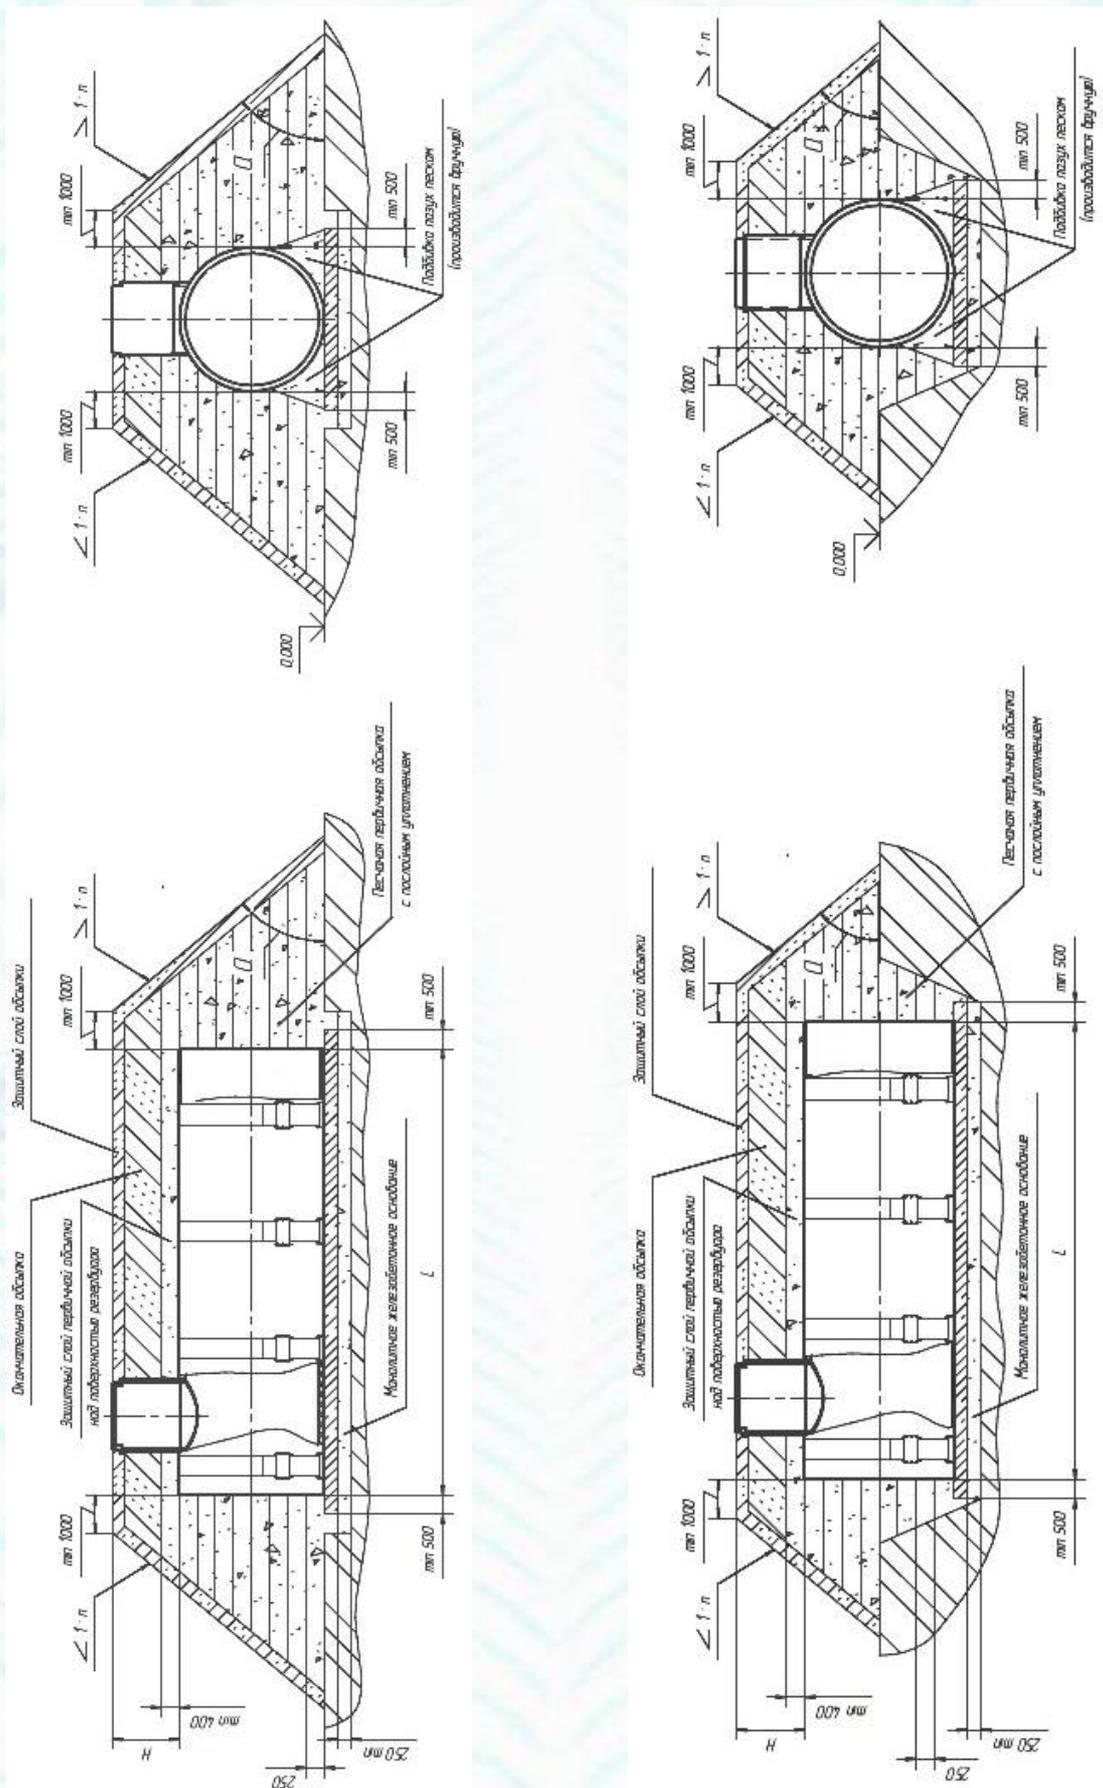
Схемы монтажа резервуара в насыпи на бетонном основании
